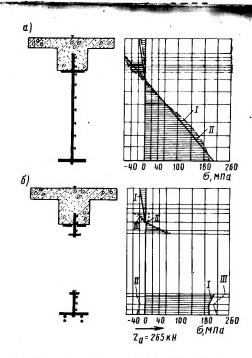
Эпюры нормальных напряжений в сталежелезобетонных балках на второй стадии нагружения
